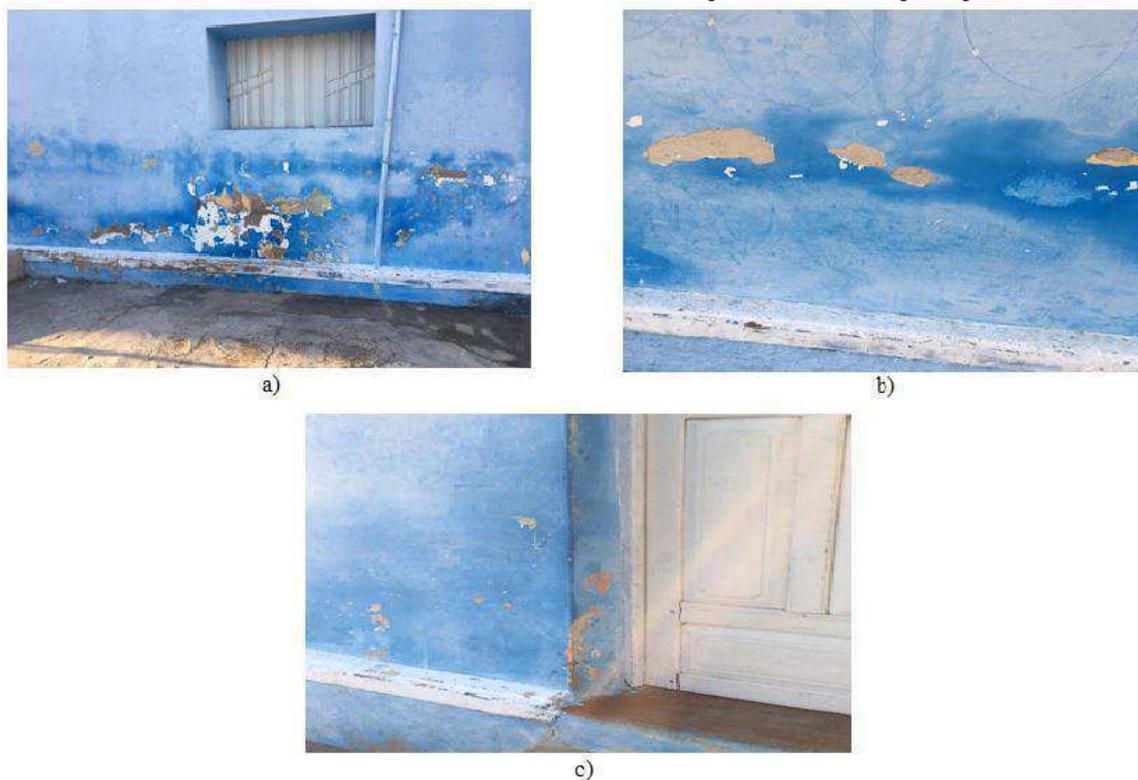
Descolamento do revestimento na fachada principal: a) Tinta sobre tinta; b) manchas de umidade na base da fachada.
